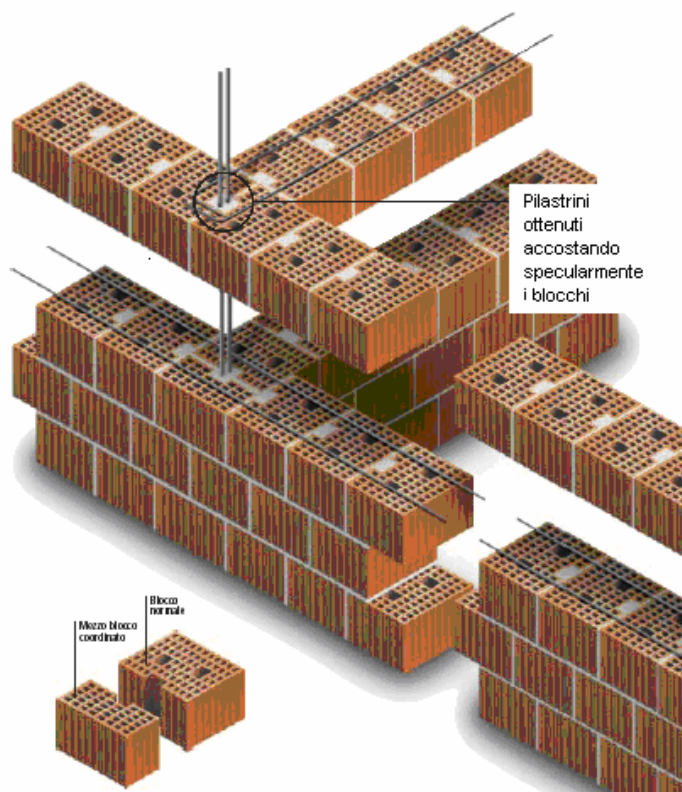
Murature armate con armatura nei “pilastrini” ricavati accostando i blocchi in laterizio – Blocchi Alveolater®
